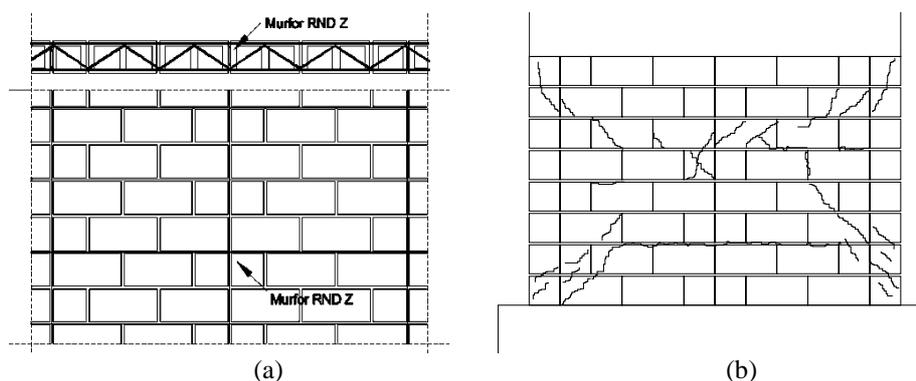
Alvenaria moderna armada (solução em desenvolvimento na Universidade do Minho em colaboração com a empresa Costa & Almeida, Lda): (a) solução adoptada para as armaduras verticais e horizontais; (b) padrão de fendilhação em paredes de corte submetidas a acções cíclicas [8].
